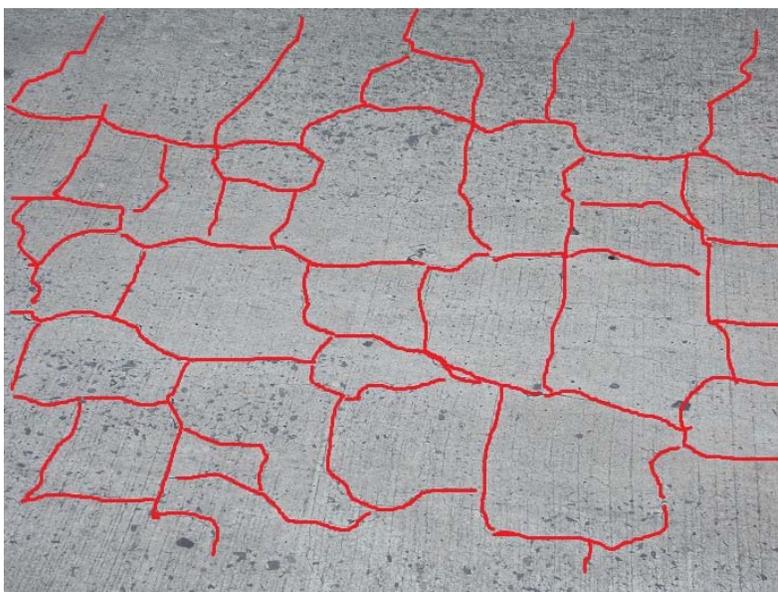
Agrietamiento típico observado en la losa de concreto.
